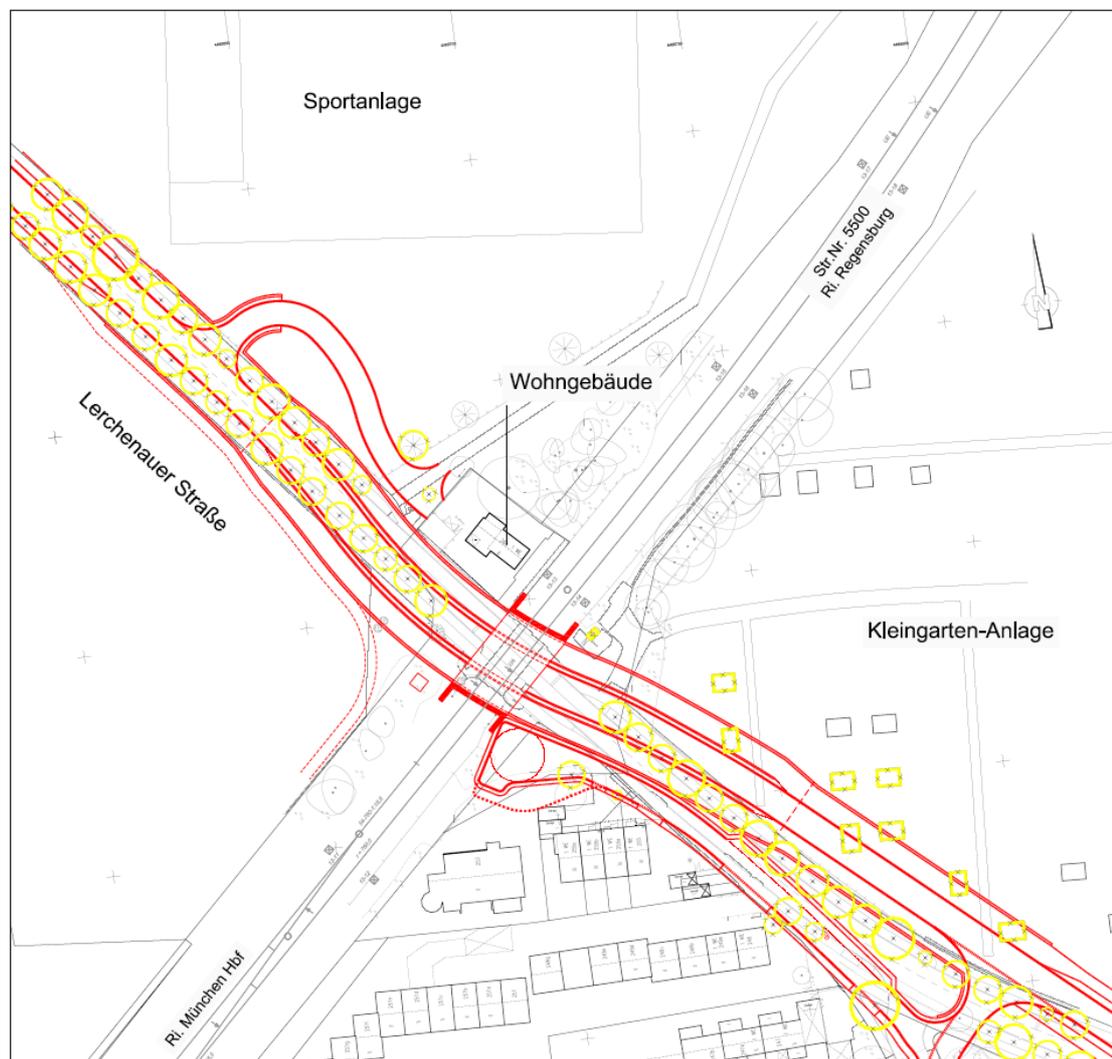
Lageplanausschnitt Variante 2 - verschwenkte Straßenführung
